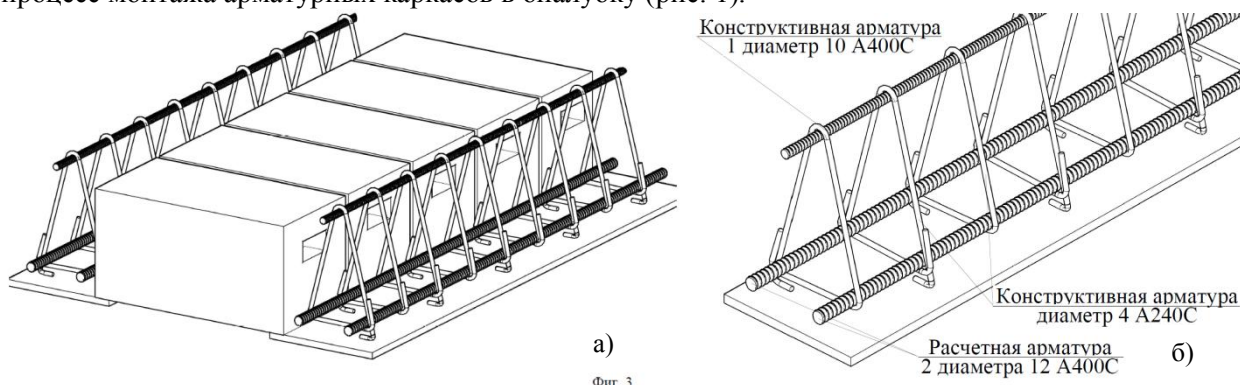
Предлагаемый элемент усовершенствованного сборно-монолитного бетонного перекрытия и его армирования:
